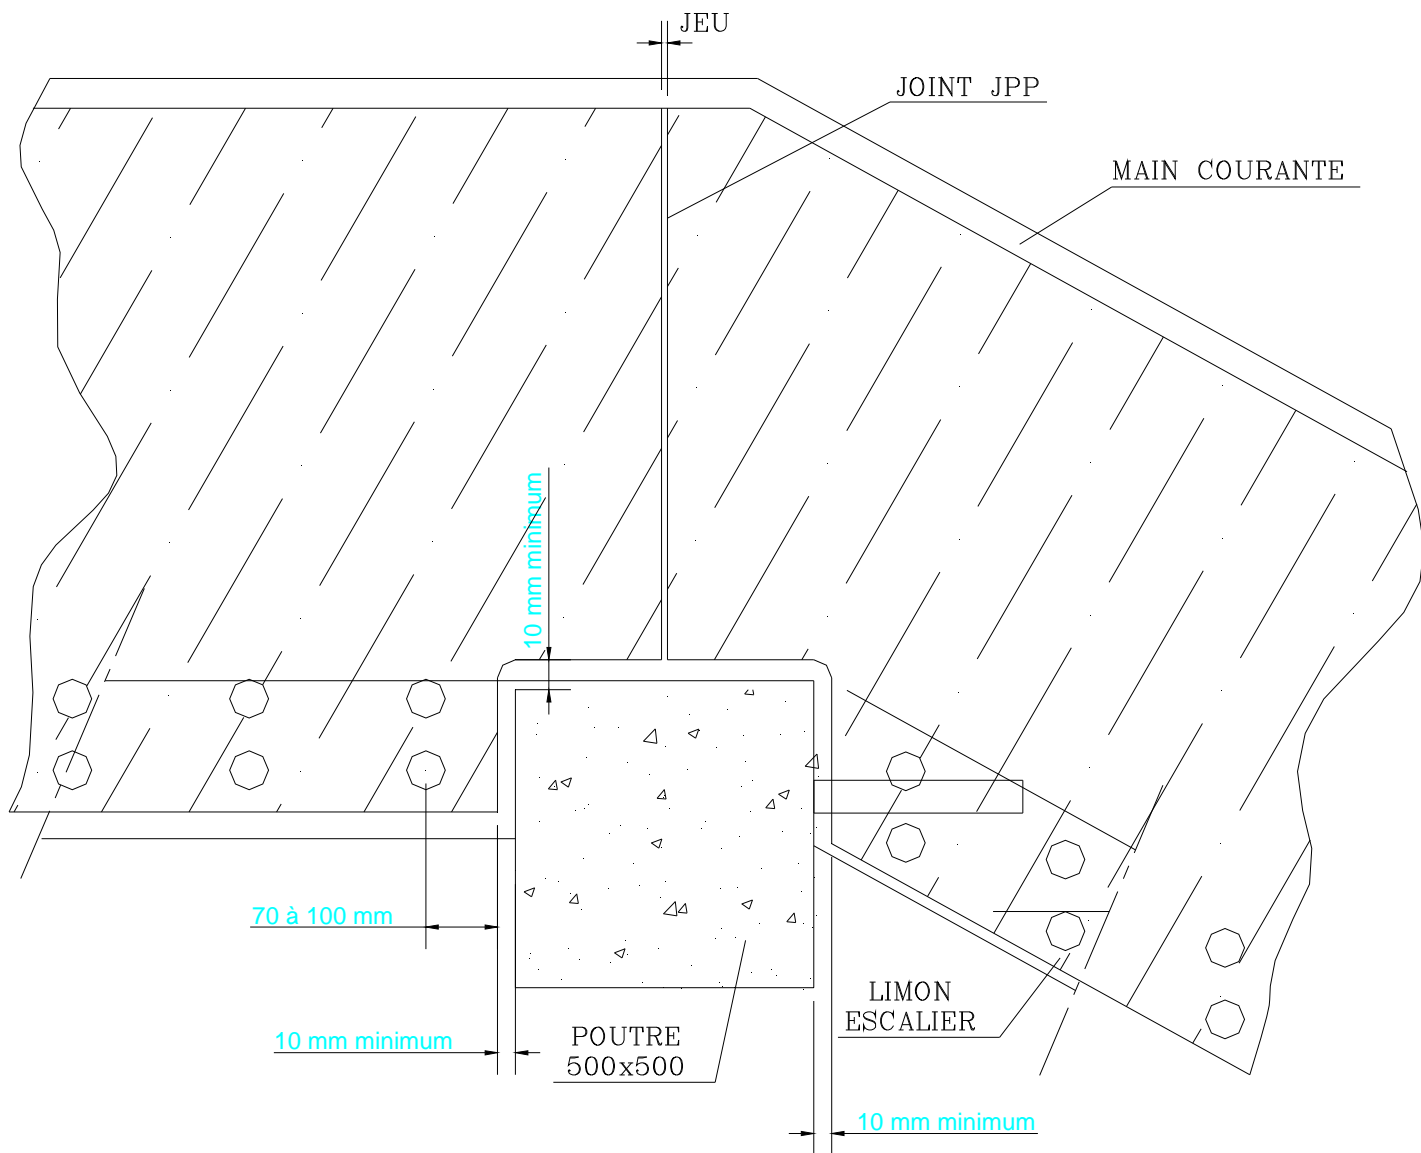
is – Cas d'une encoche (pour passage de poutre)
